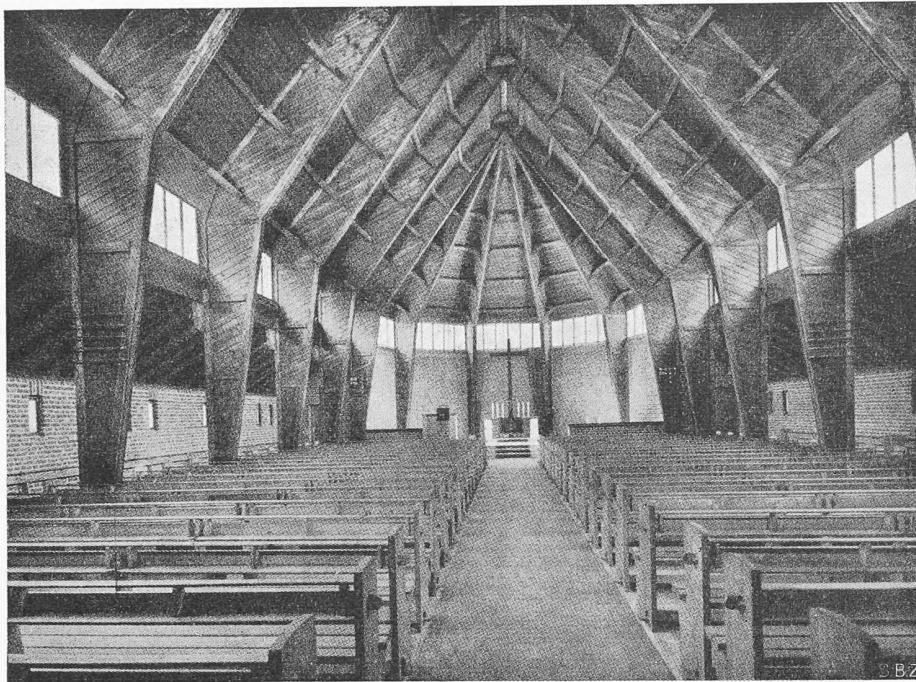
Notkirche, typisiert und vorfabriziert. Arch. O. BARTNING
